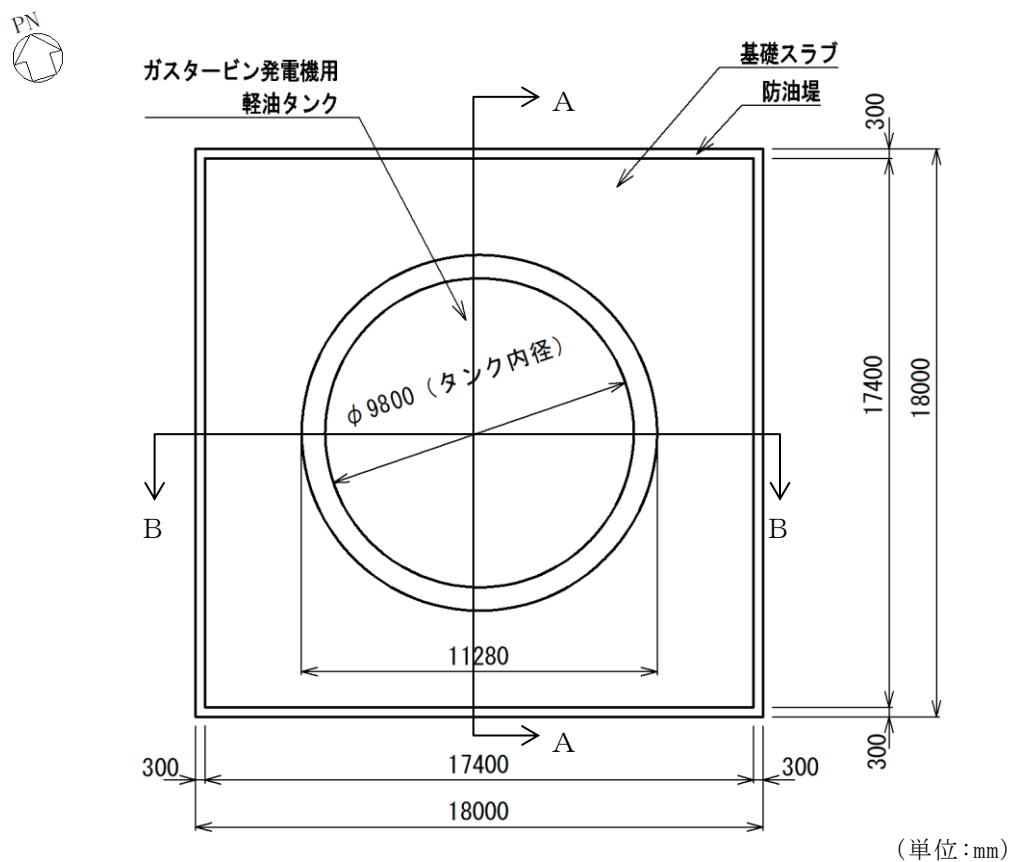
ガスタービン発電機用軽油タンク基礎 平面図
